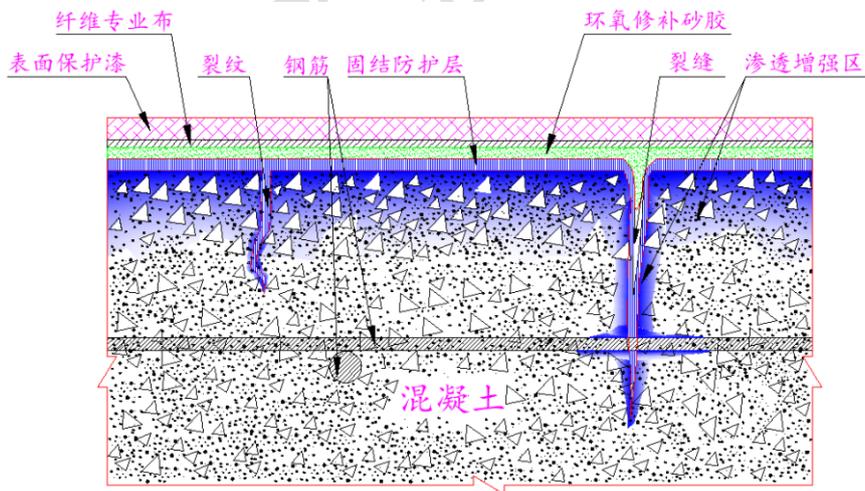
混凝土表层结构渗透增强防护体系示意图
